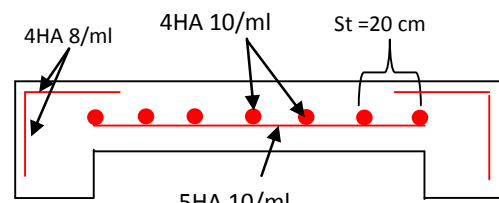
Coupe A-A de la dalle du RDC (4 appuis)
